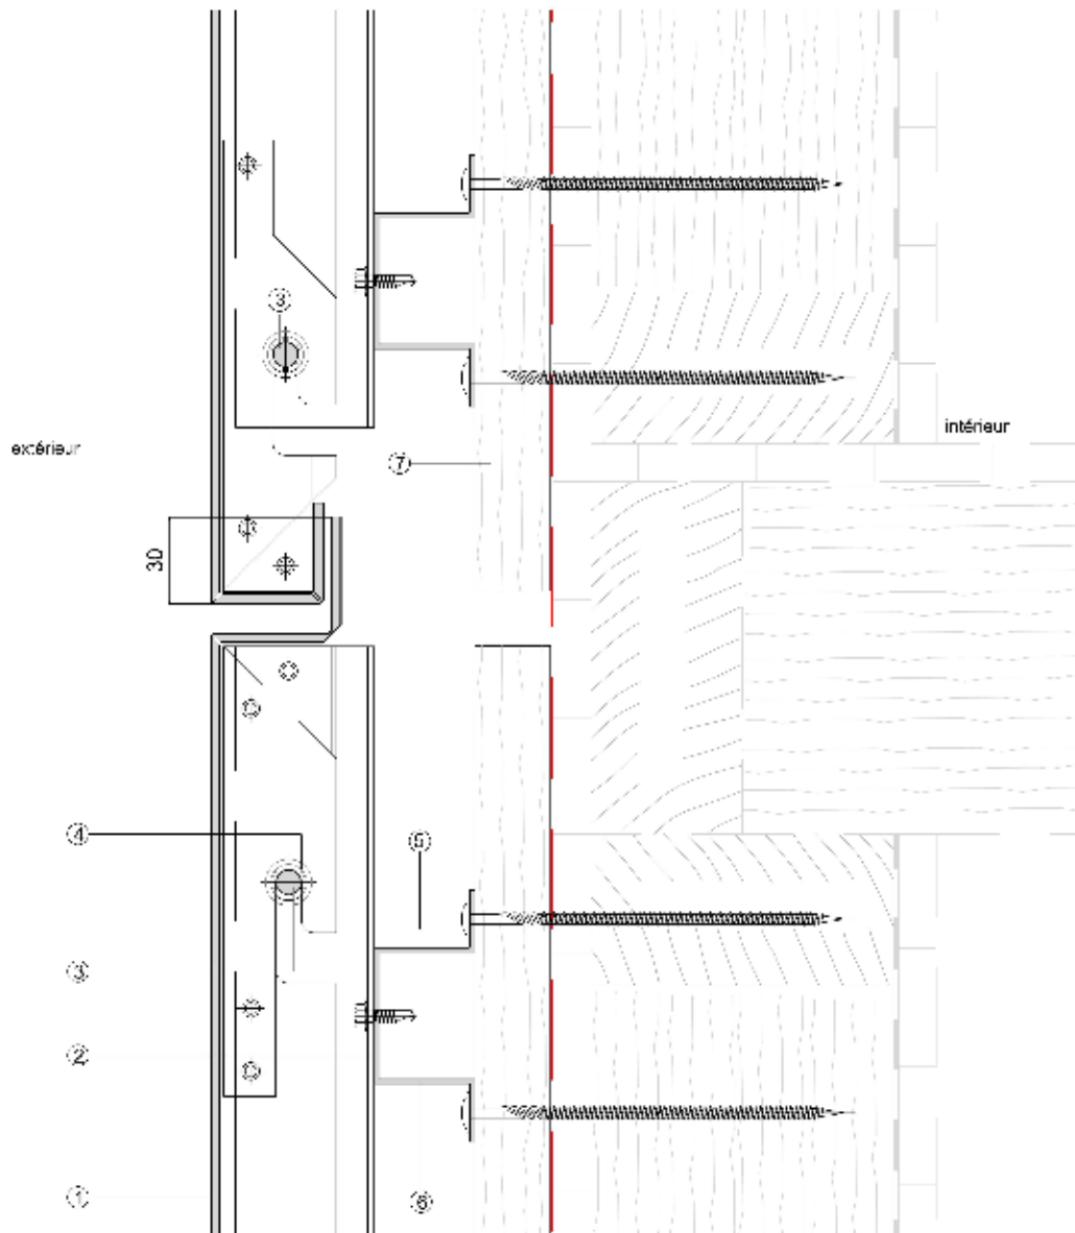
Coupe Verticale - Fractionnement de l'ossature au niveau de chaque plancher lisse horizontale Omega
